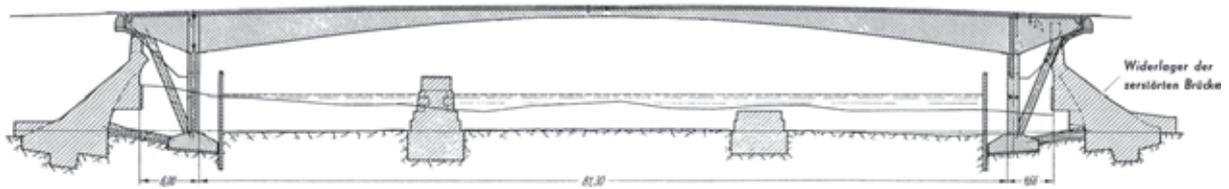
Gänstorbrücke Ulm, Längsschnitt
